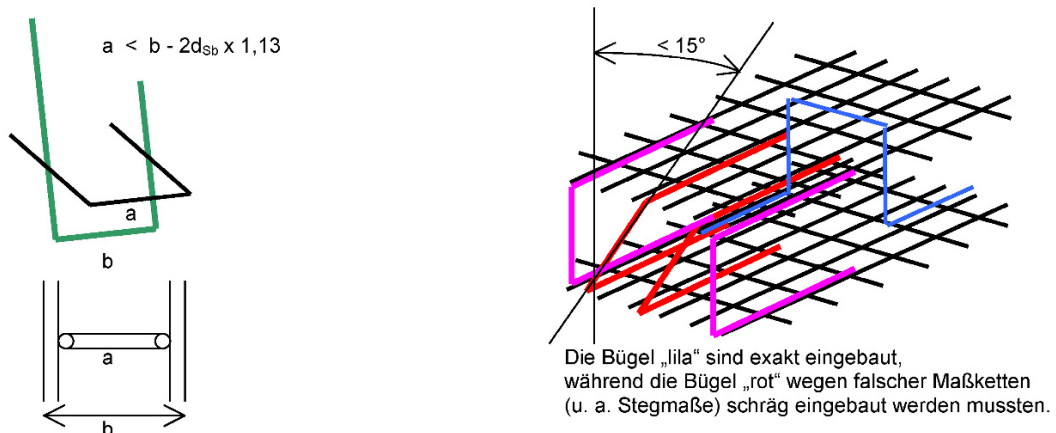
Maße beim Ineinanderschieben und beim Verdrehen von Betonstahlformen im Geflecht.
